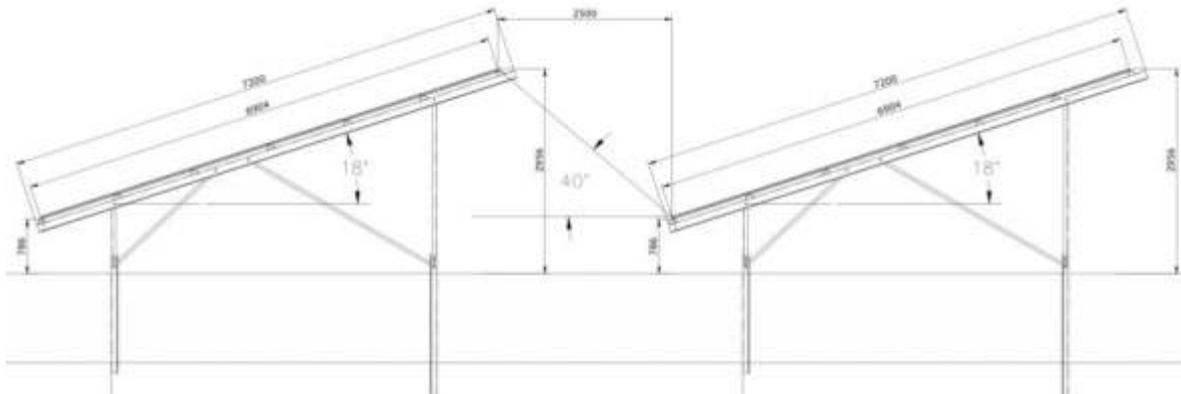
Skizze der Modulkonstruktion (Quelle: Planungsunterlagen, Bsp.)
